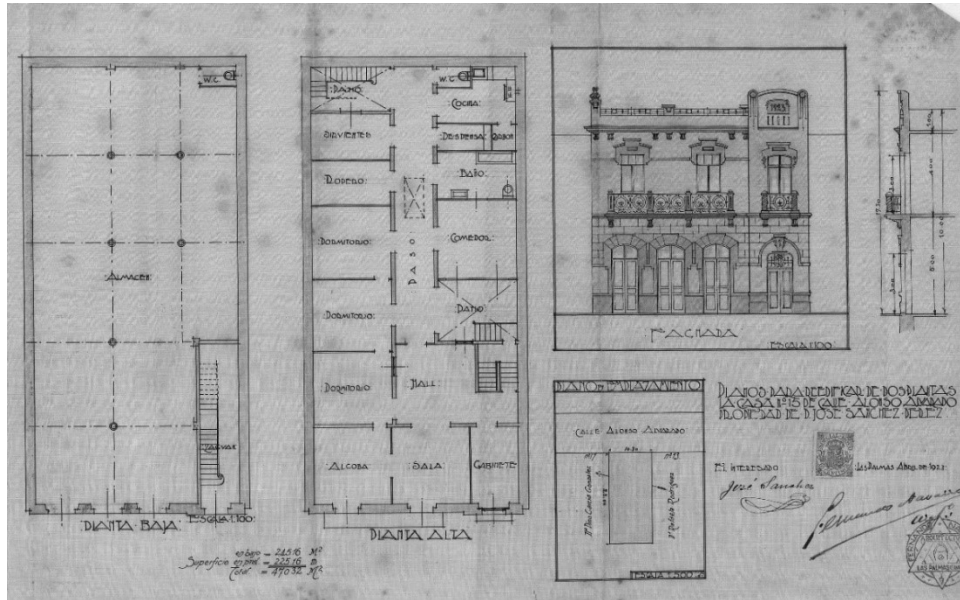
Planos del proyecto de edificio de dos plantas en hormigón armado, calle Alonso Alvarado. Arquitecto Fernando Navarro. Año 1923. Archivo Histórico Provincial de Las Palmas.
